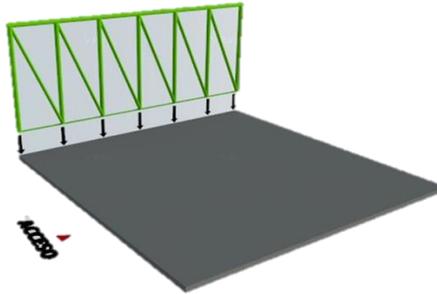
Módulo prefabricado vivienda emergente.
